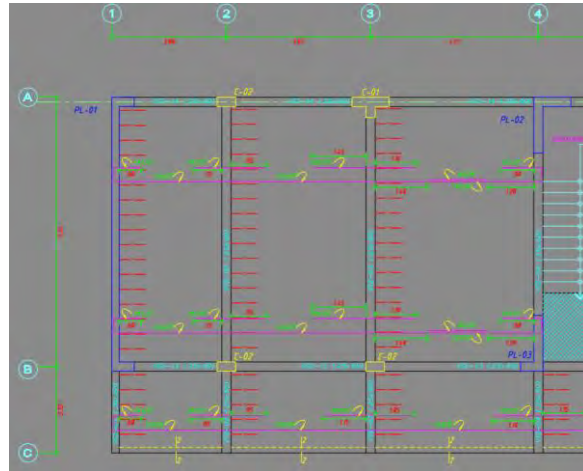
Elementos estructurales verticales en la zona de baños. Fuente: Propia
